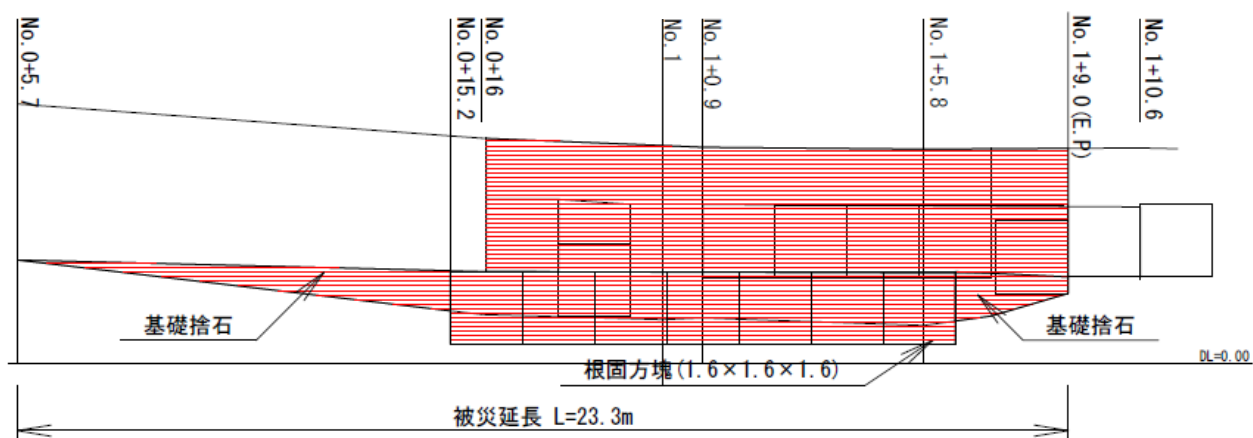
No. 8 南海浜埋立地導流堤の縦断面図（北側）（被災後）
